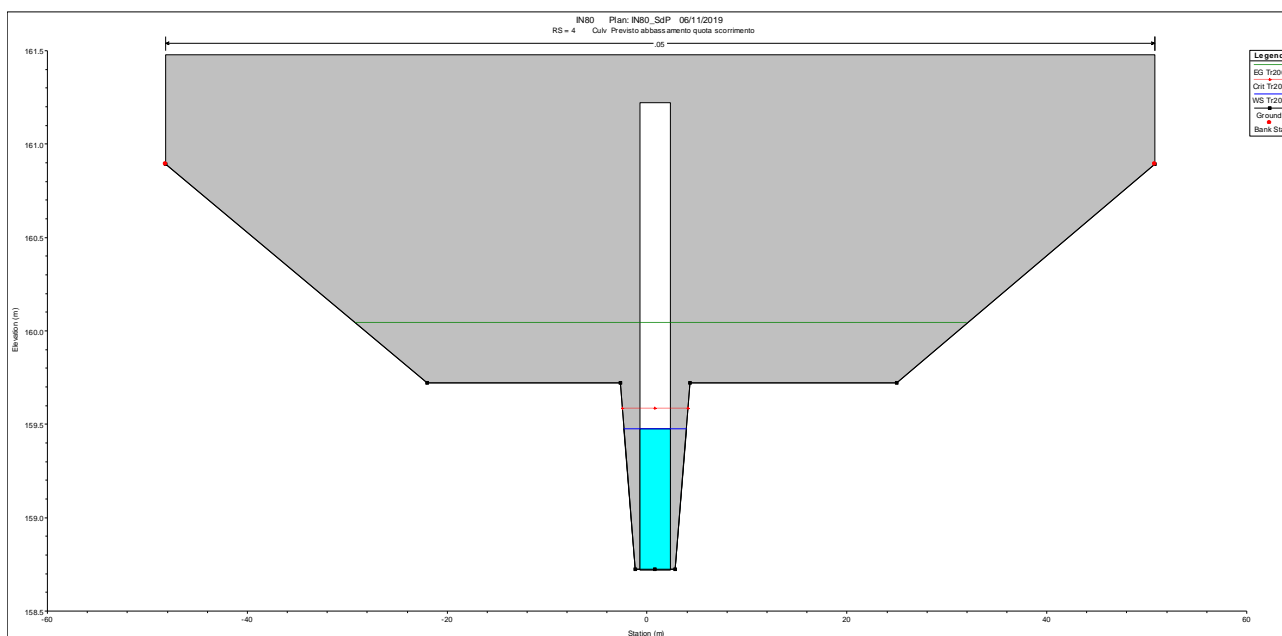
Sezione valle manufatto 2 – stato di progetto interferenza IN80.
